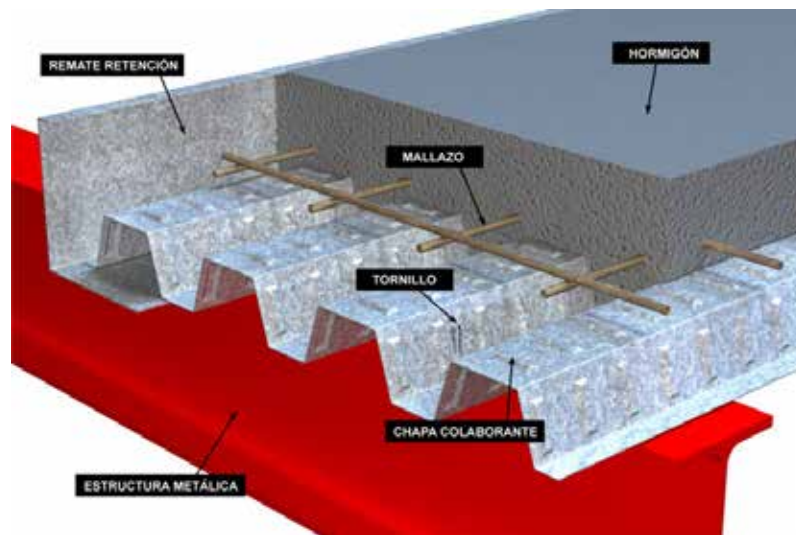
Sistema de Losacero. Fuente: <http://www.arquitecturaenacero.org/> (2010)
